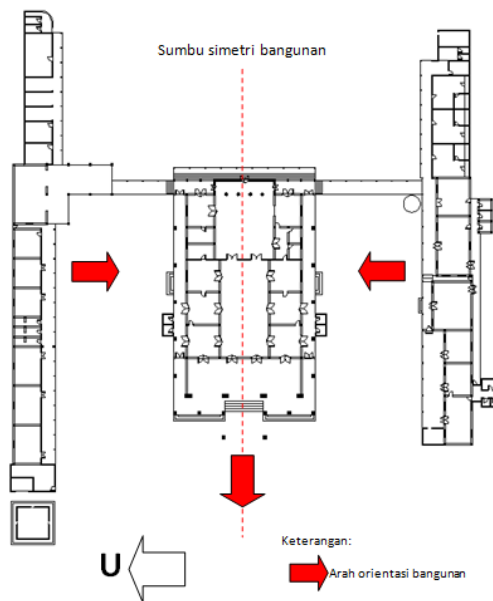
Denah bangunan eks rumah Dinas Residen Kediri
